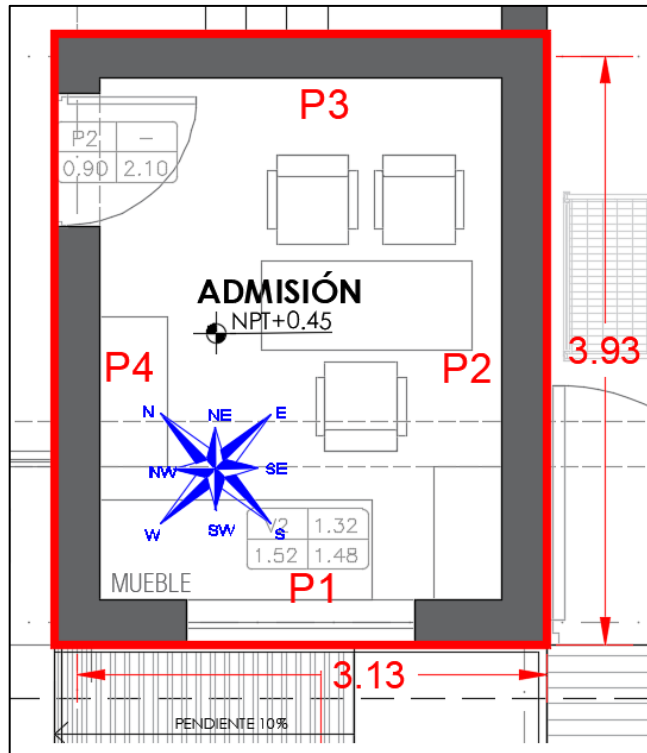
Vista de planta con la distribución del área de ADMISIÓN, tomado de los planos de arquitectura brindados por el propietario de ANIQUEM.
